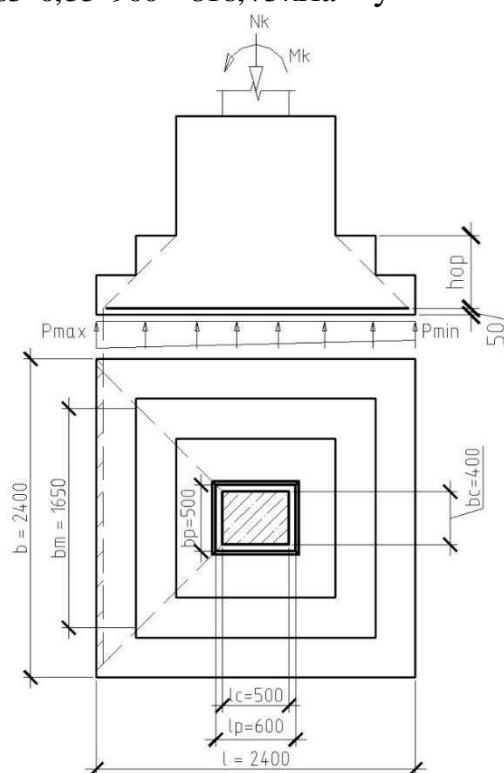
Схема к расчету низкого фундамента на продавливание подколонником
